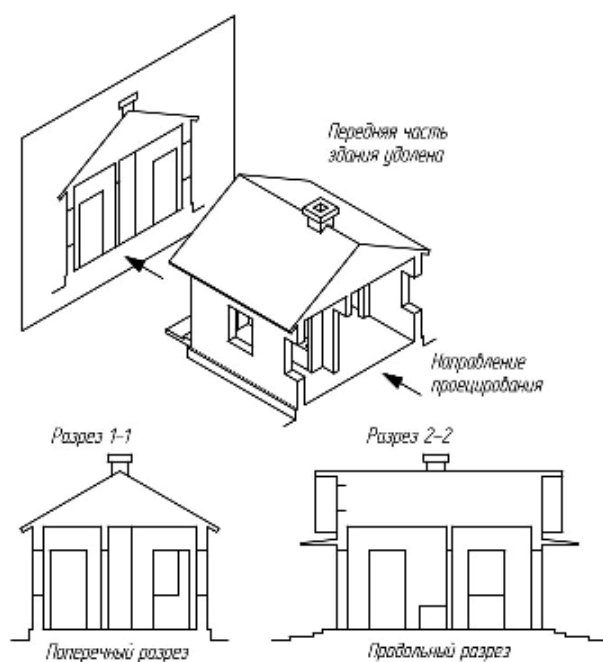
Образование продольного и поперечного разрезов здания
